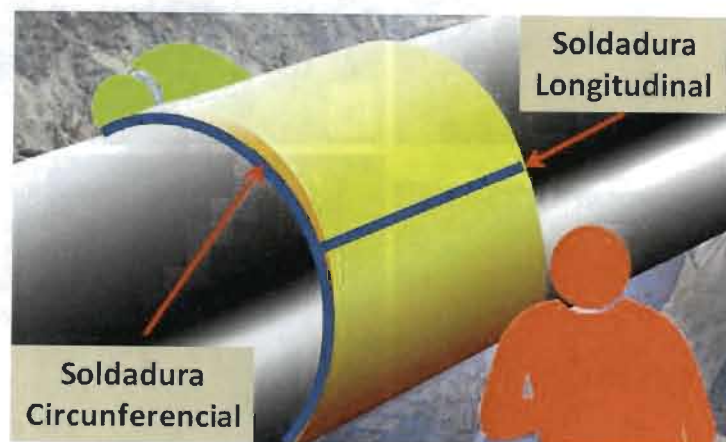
Encamisado Completo Tipo B con soldadura circunferencial y soldadura longitudinal sin espacio anular, diseñado como contenedor de presión [13]
